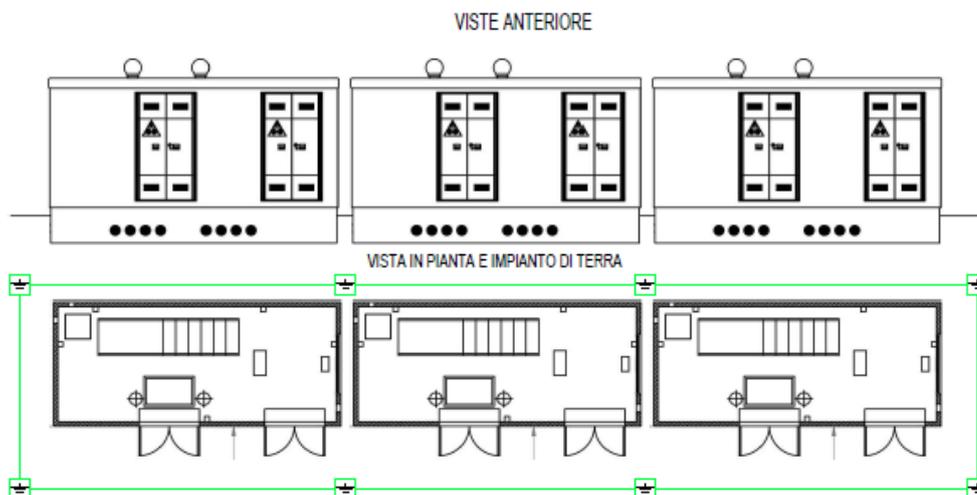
Pianta e prospetto cabine di sezionamento
